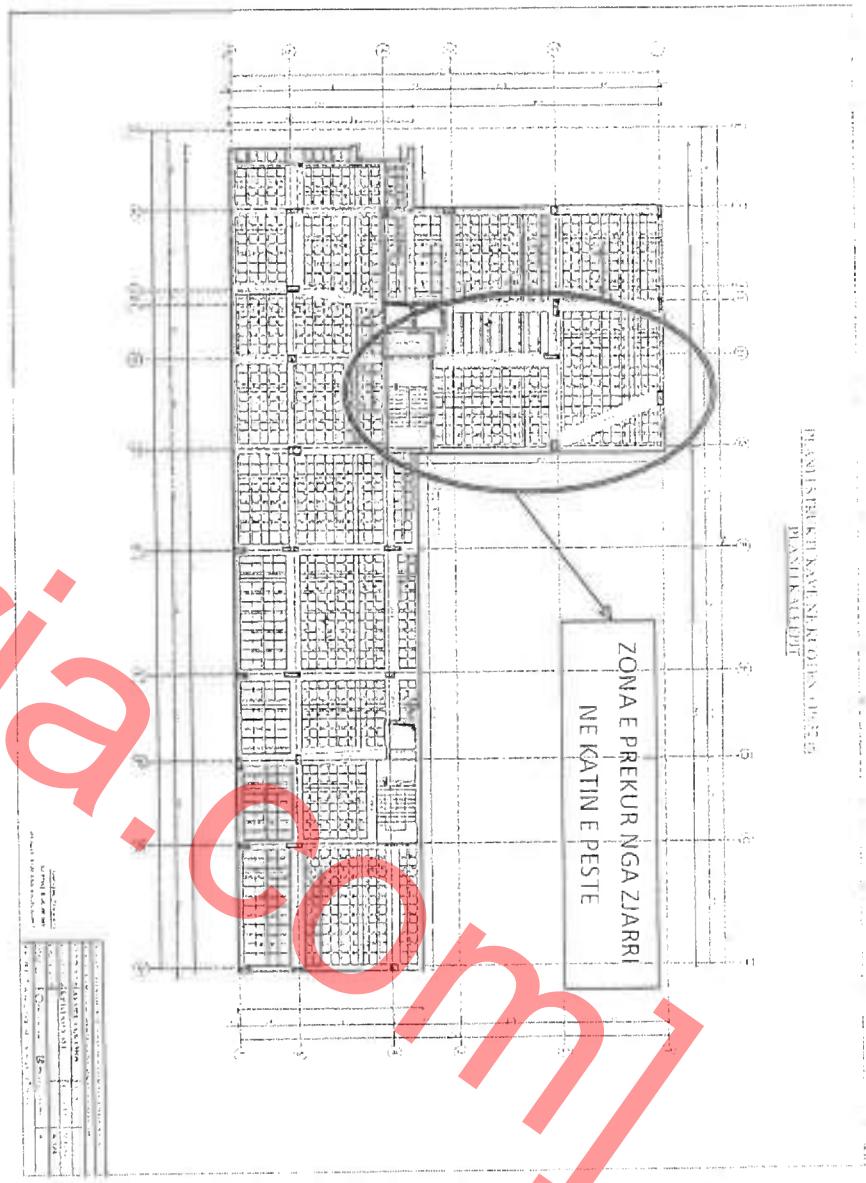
Plan i Strukturave ne Kuoten +22.79 m, Plan i Kallepit
